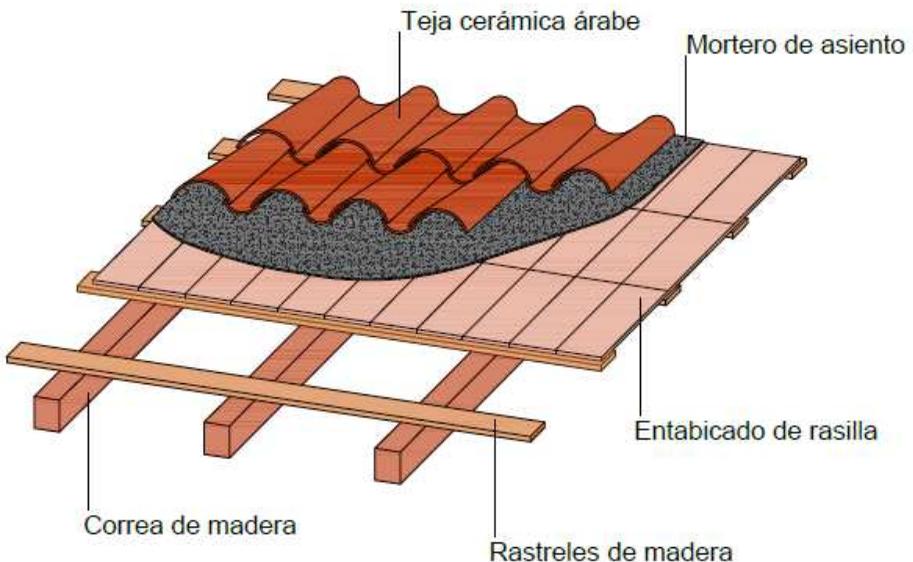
Detalle cubierta entabcada de rasilla. Autor propio
